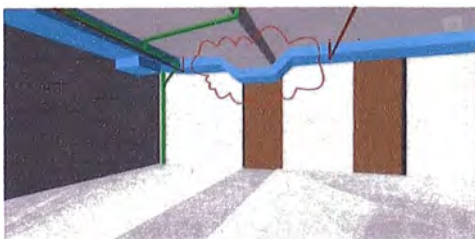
Imagen de colisión del auto con ducto y solución planteada
